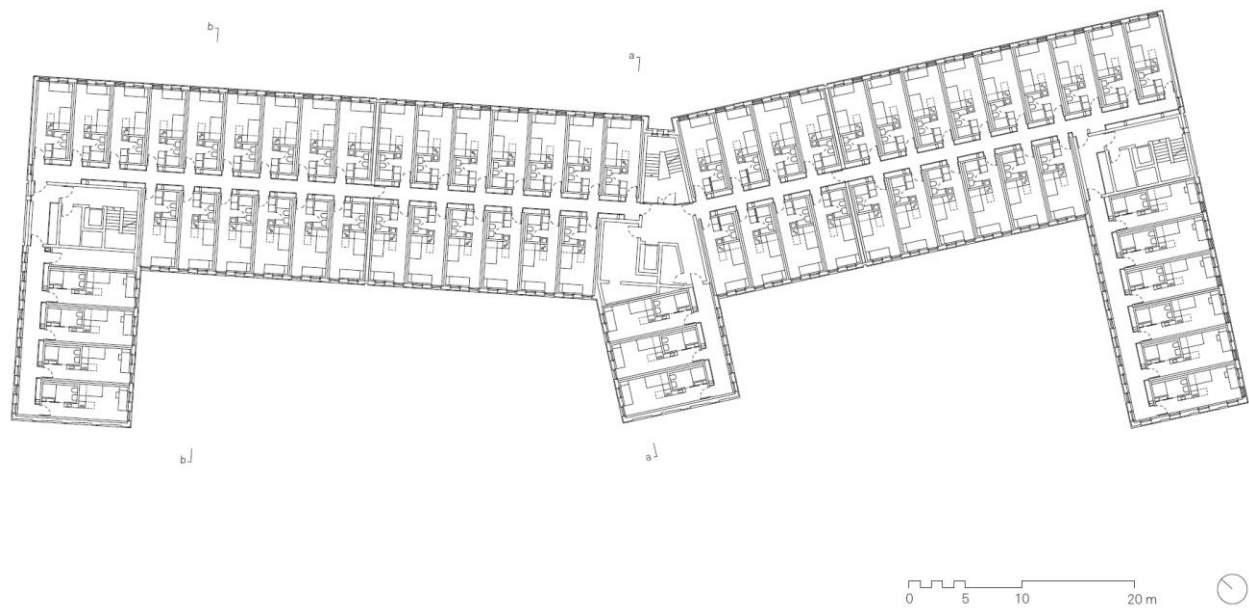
Grundriss eines Regelgeschosses des Studentenwohnheims in Raummodulbauweise (Holzkonstruktion) in Hamburg, Deutschland (Urheber: Sauerbruch Hutton)
